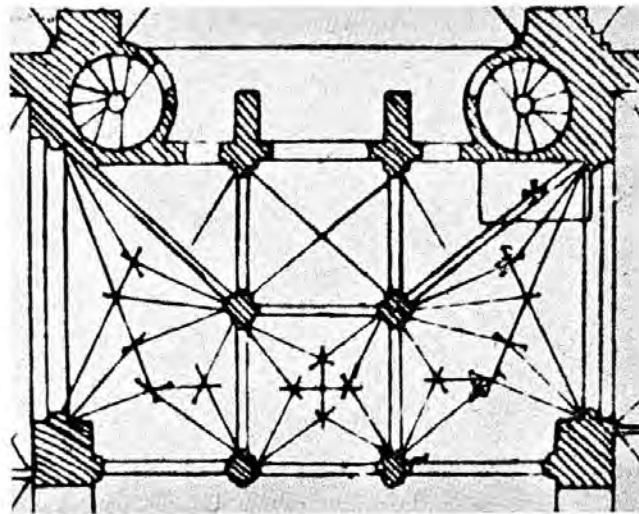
Lettnergrundriss - Detail aus dem Erbschen Grundriss der Aschaffener Stiftskirche von 1625.
